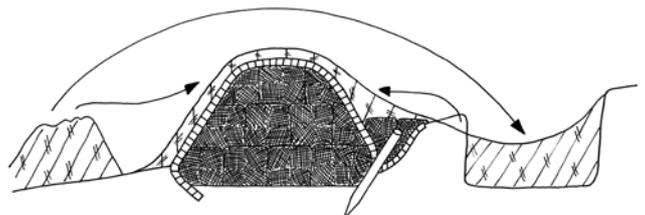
Querschnitt des Walles mit verankerter Kokosfasermatte und Torfabdeckung
